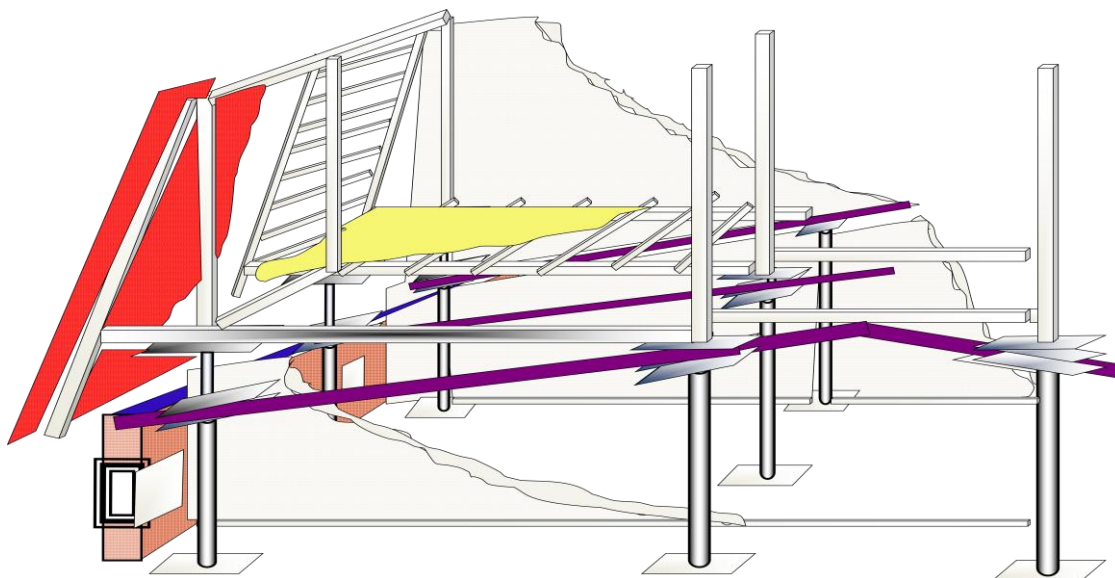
Схема надстройки 2-го этажа при реконструкции здания фермы, реабилитируемой в «Энергоэффективный дом»
